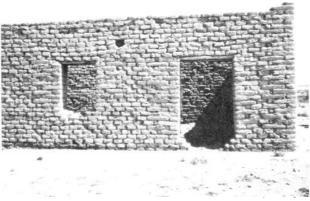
Gros-œuvre d'une maison en construction (Khoueish, Syrie).
